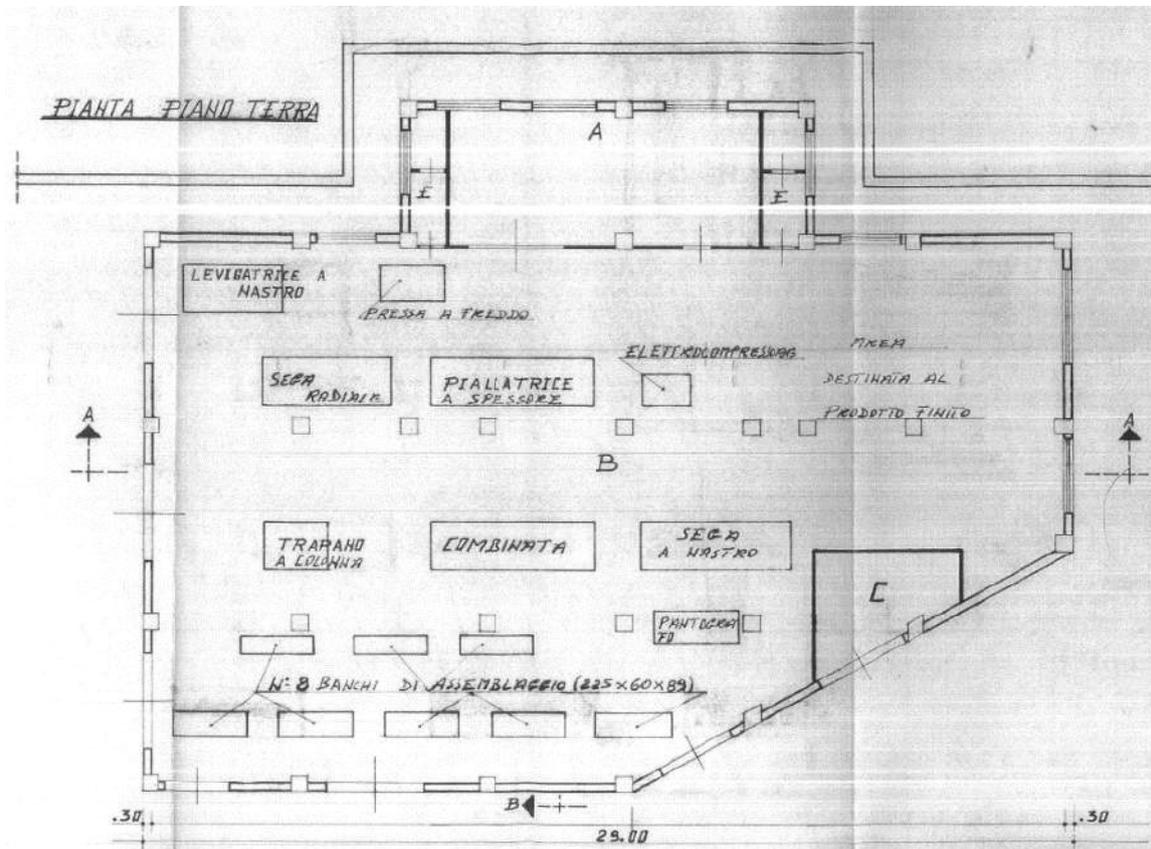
Pianta originaria del laboratorio artigiano di falegnameria predisposto in un unico ambito del piano terra/ seminterrato
